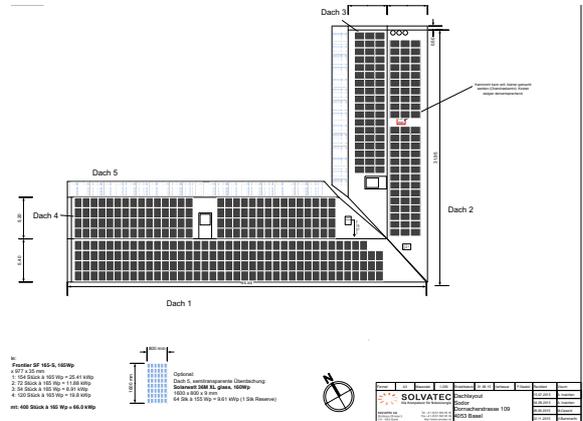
Layout Solaranlagen Dach und Glasdach hofseite
